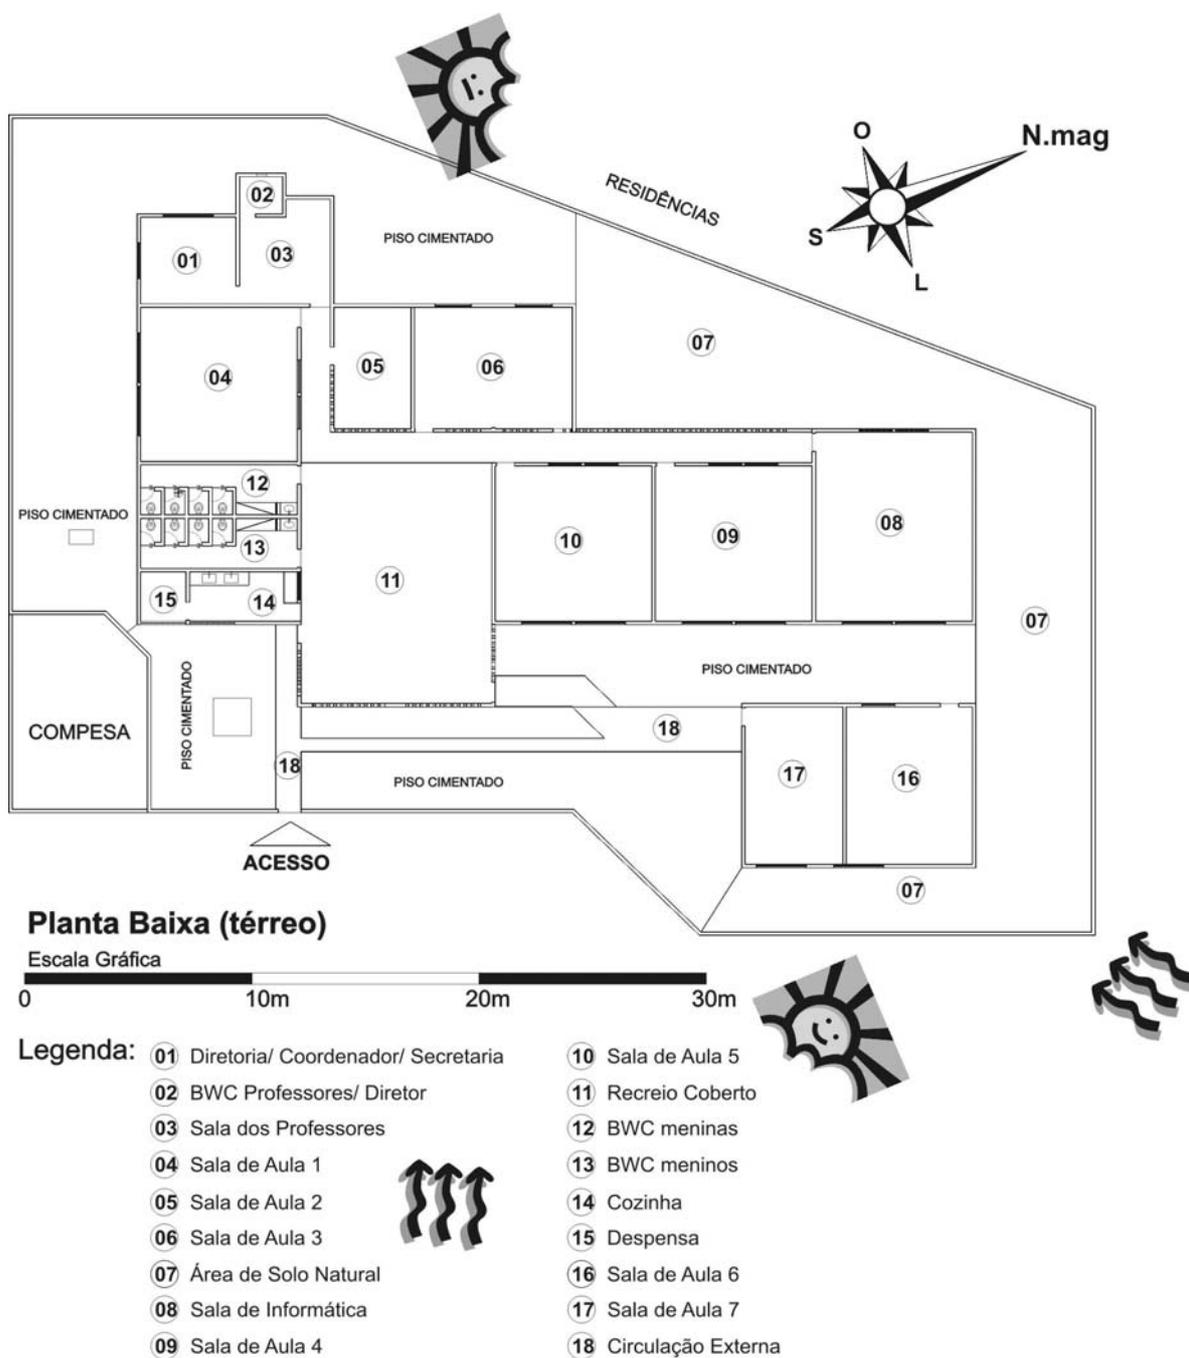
Escola 1, planta baixa do térreo (2004).
